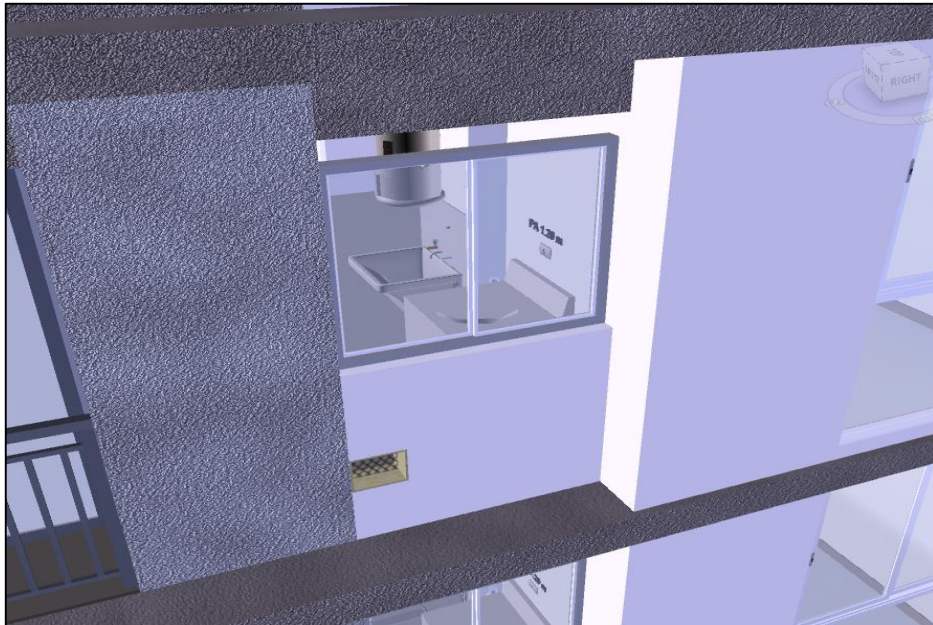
Rejillas de ventilación en la Fachada del proyecto Elant.
